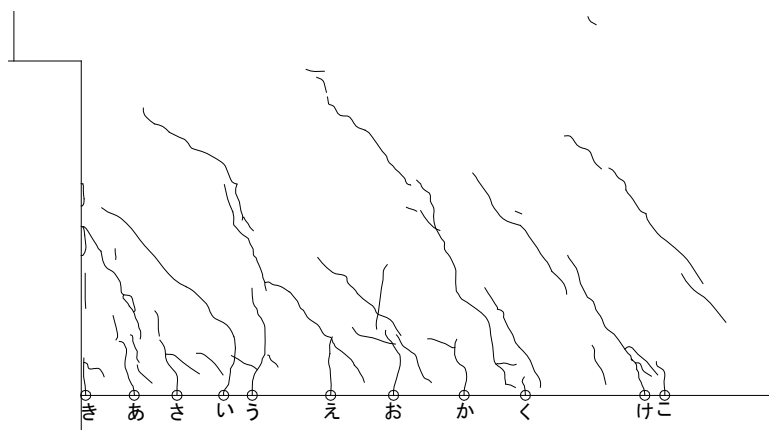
基礎梁ひび割れ幅測定位置(試験体 A-6 正載荷)
